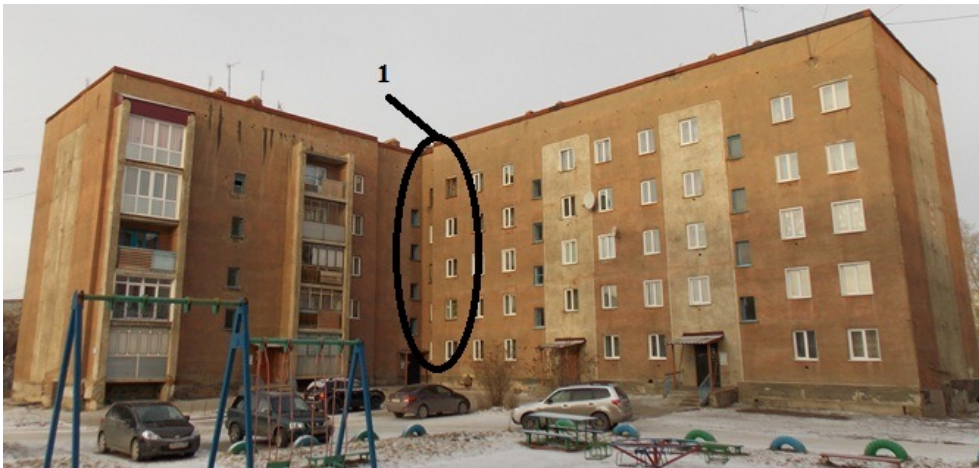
Здание сложной формы в плане без антисейсмического шва. 1 – место образования трещин
